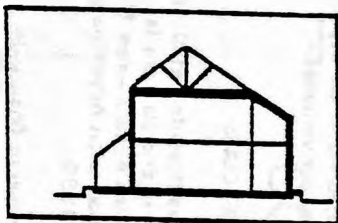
Detalle de platea de fundación en SUM. Muros de baja inercia térmica y zócalo de piedra bola.
